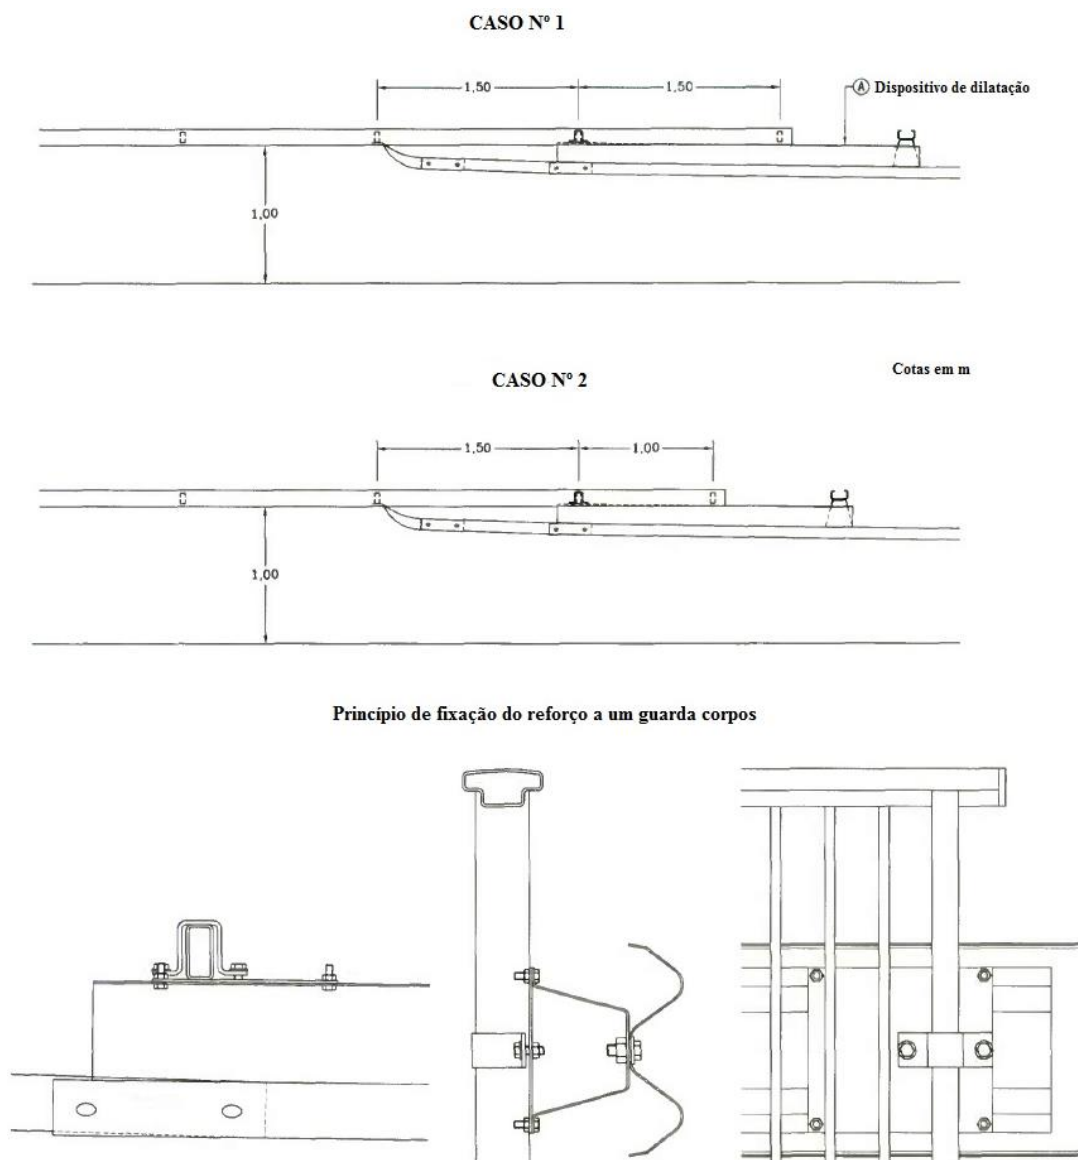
Ligação entre dispositivo e guarda corpos: tráfego elevado, adaptado SETRA [17]
